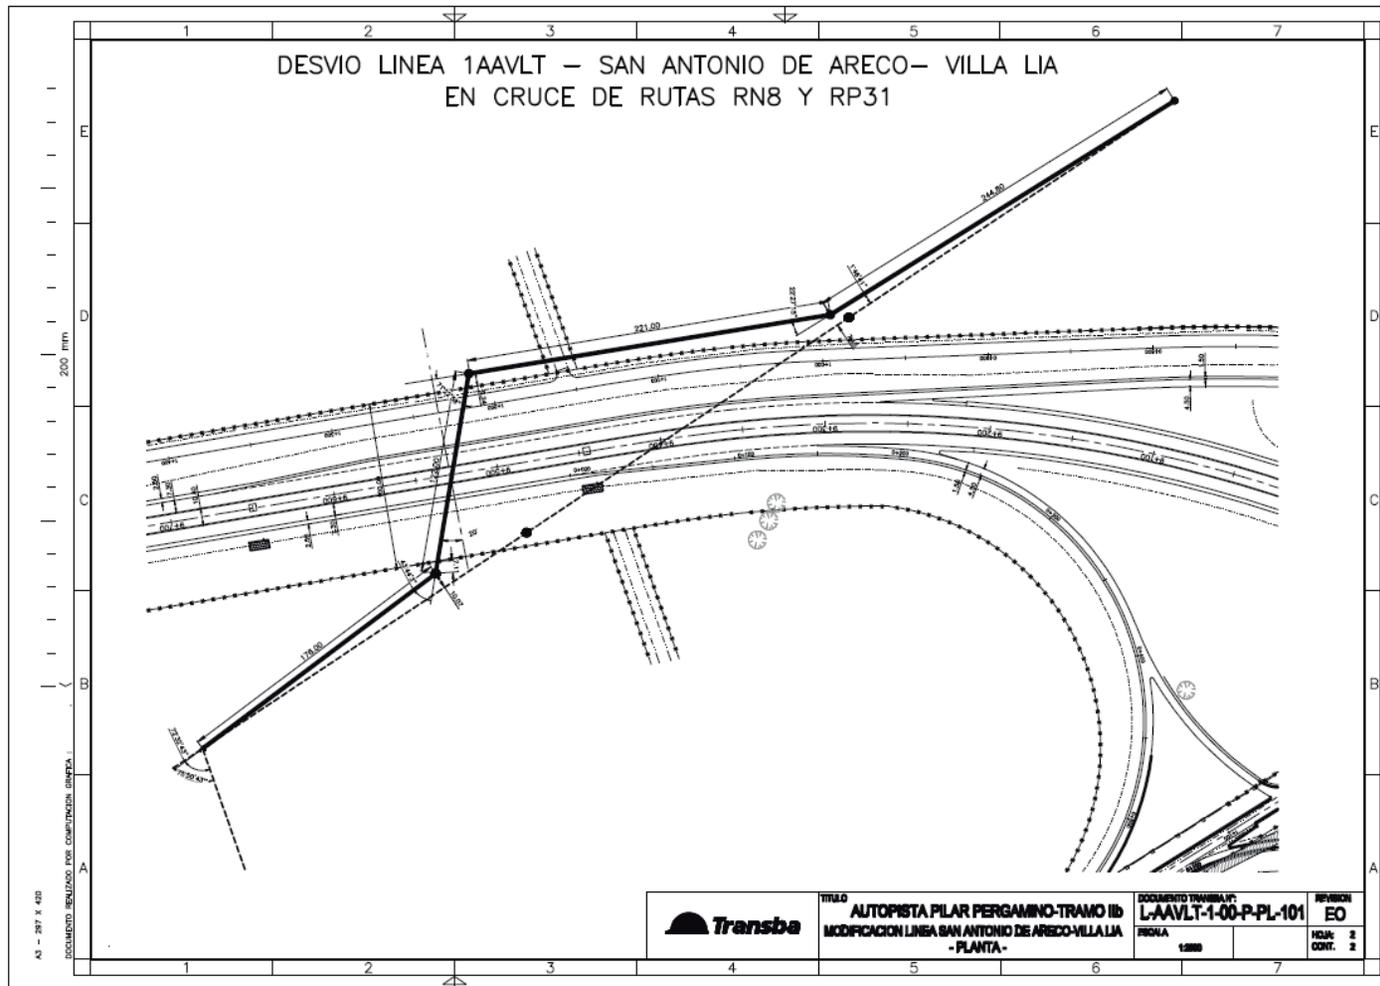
Autopista Pilar Pergamino (Ruta Nacional N° 8) – Adecuación de la LAT 132 kV San Antonio de Areco – “T” Campana / Villa Elia
